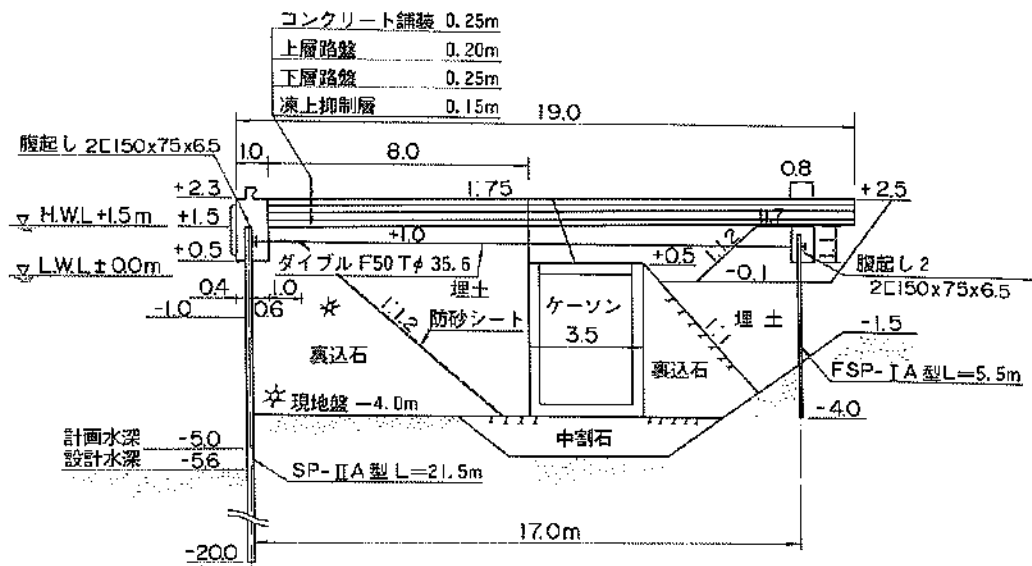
(a) 標準断面図 (霧多布港：④岸壁(-5.0m))
